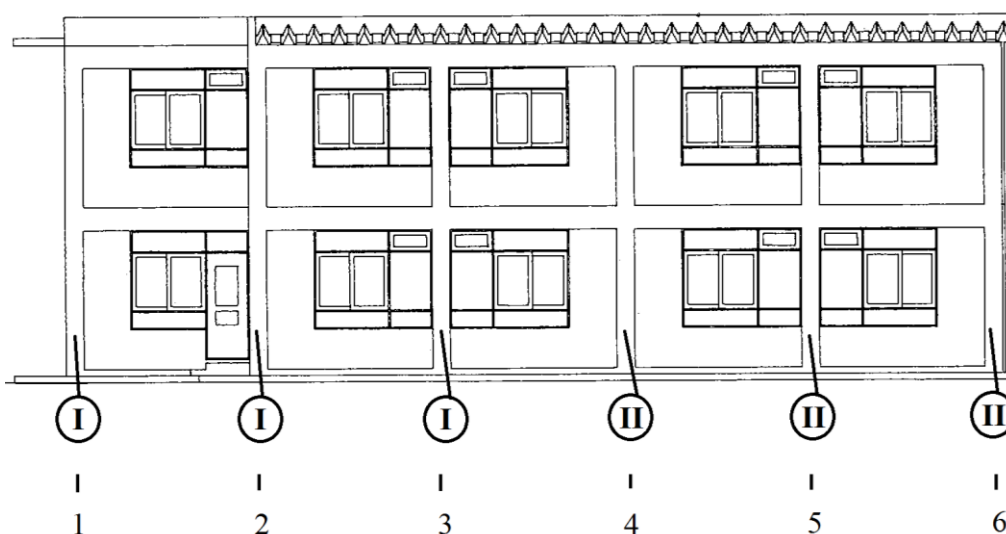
Identificação dos tipos de pilar no alçado Sul.
